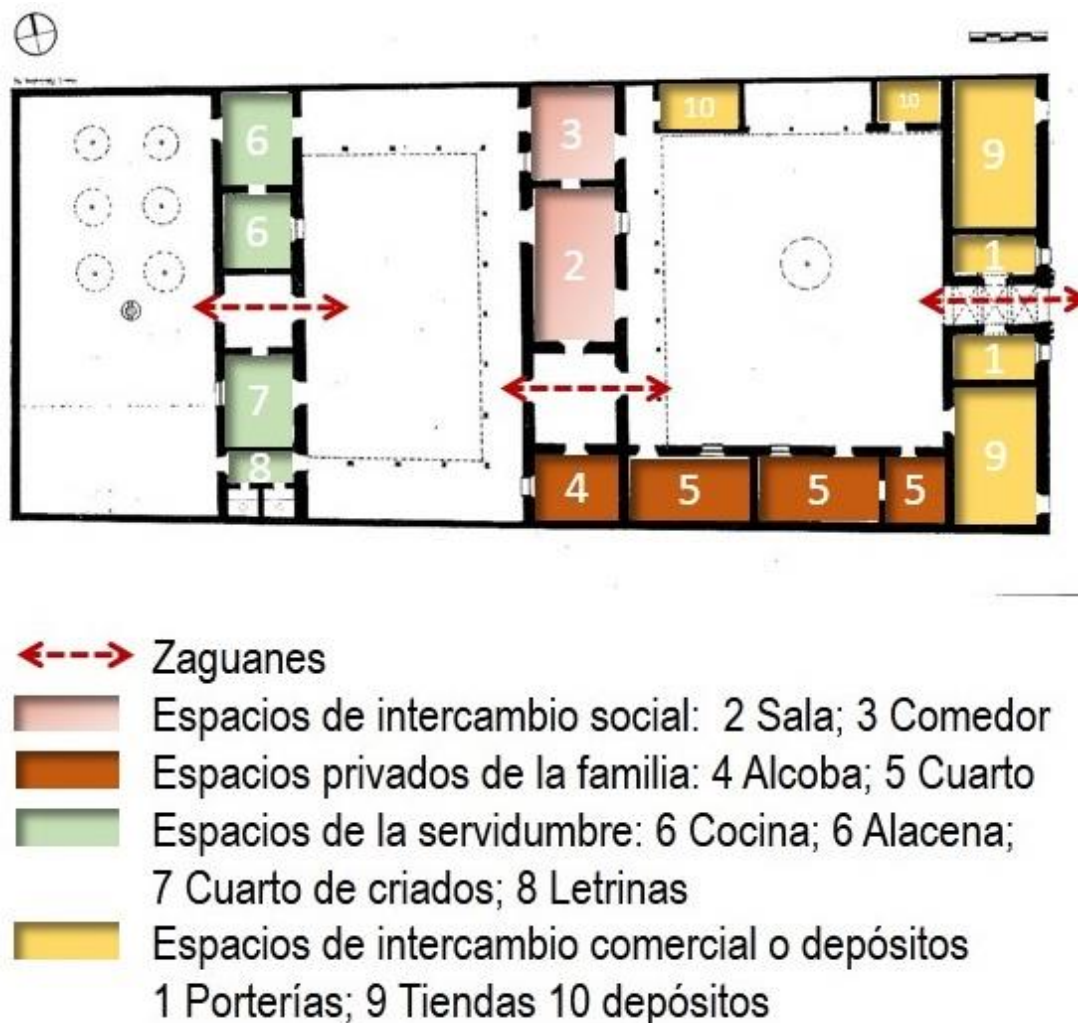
Planta de la Casa en 1838. Distribución de Espacios. Elaboración propia
